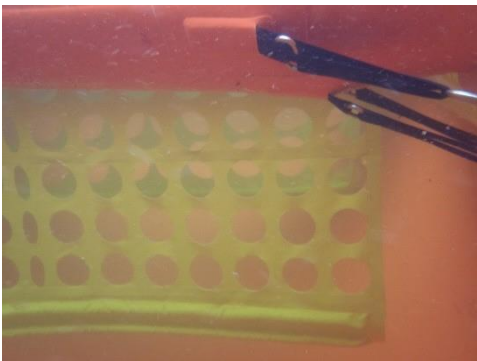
Cortina na câmara transversal nº. 4 Foto subaquática.
